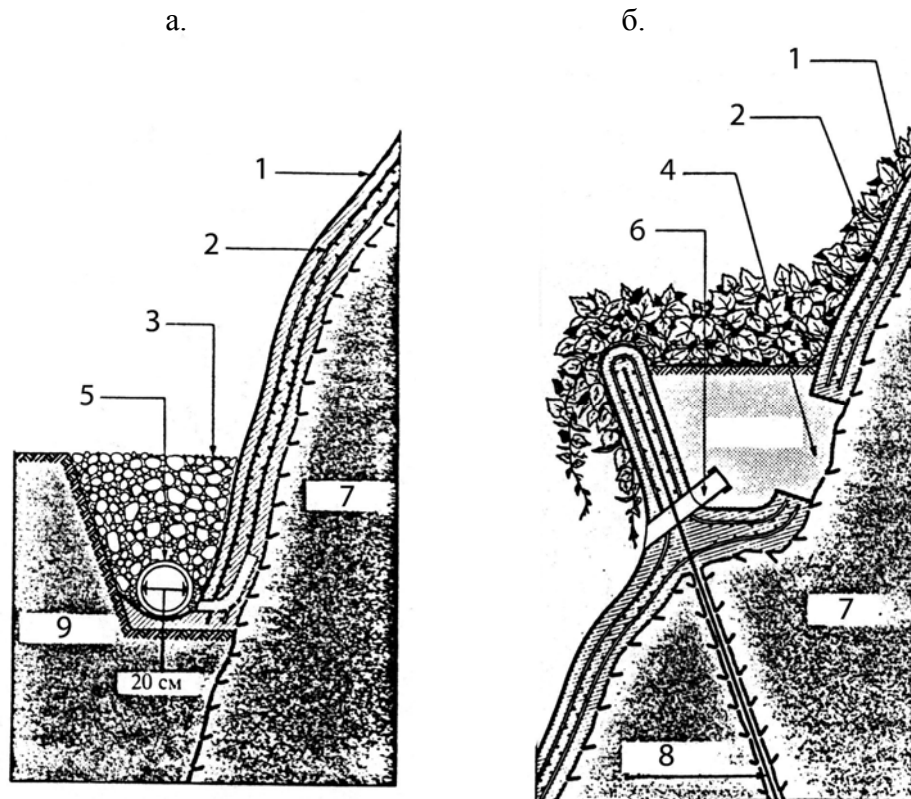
Упрочнение склона горной породы (скалы) торкрет-бетонным покрытием с различными вариантами водоотвода атмосферных осадков: с использованием дренажной системы (а) и водоотводящей трубы (б)
